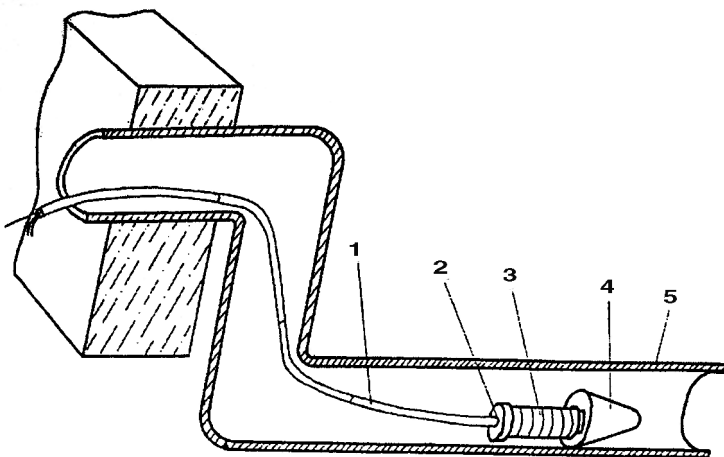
Устройство для подачи заряда при перебивании труб:
